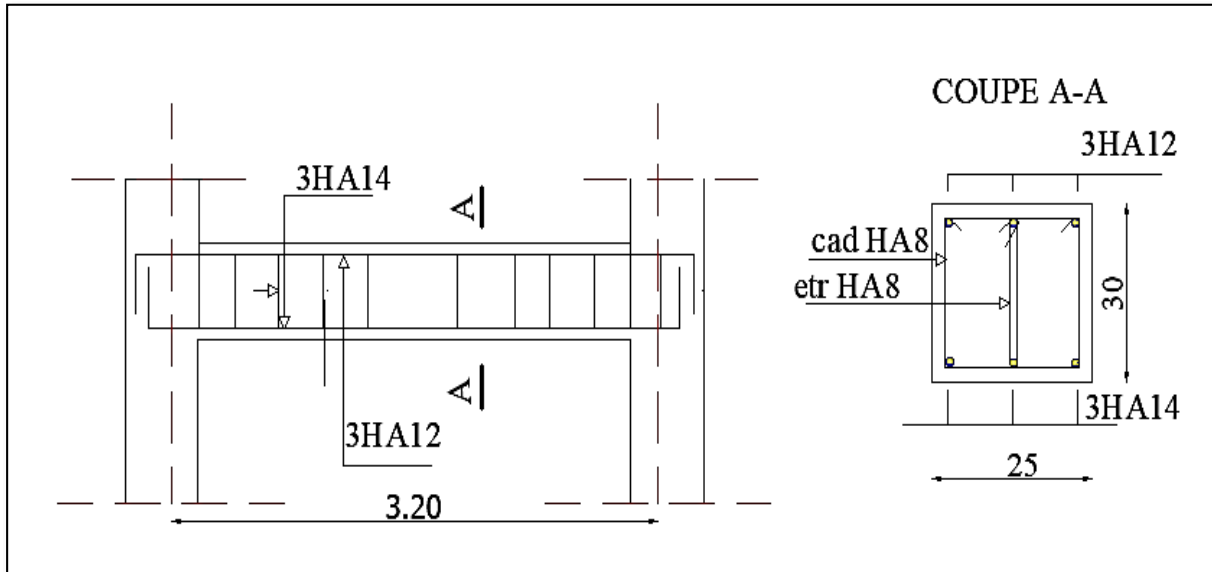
Schéma de ferraillage de la poutre palière.
